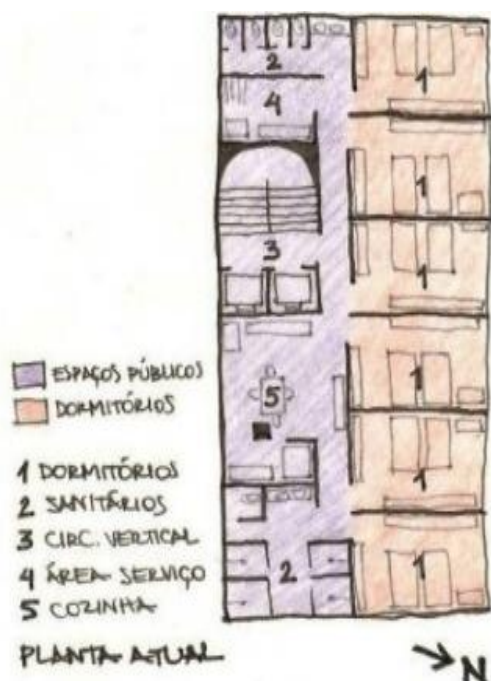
Planta do pavimento tipo. Fonte: (BOTTER, 2009)
